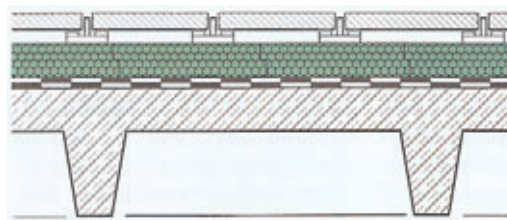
Schichtaufbau des Terrassendachs mit Stelzlagern, T 1.
